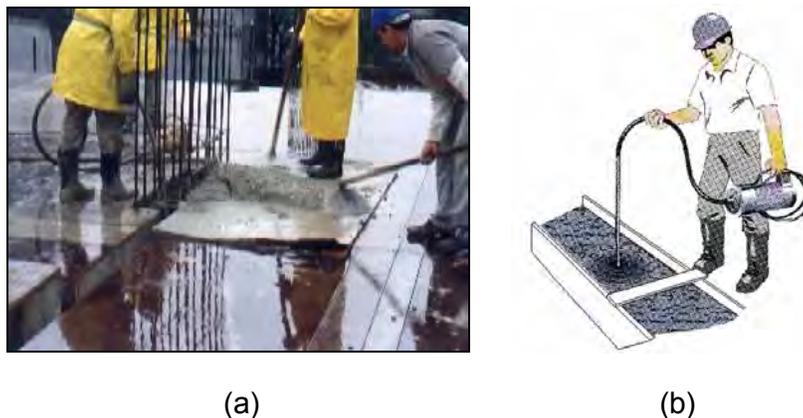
Vibradores de imersão: a) adensamento da concretagem do pilar; b) Ilustração do vibrador de imersão (Fonte: Procedimento executivo – Cyrela).
